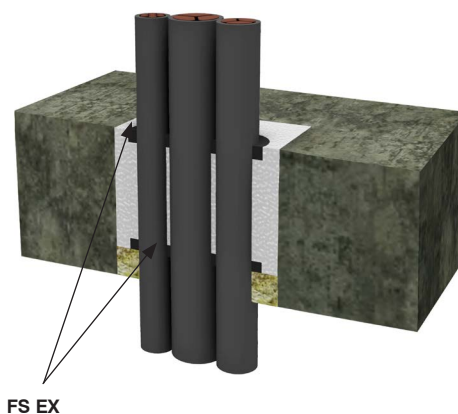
Betongplatta 150 mm. Tjocklek GPG 200 mm
